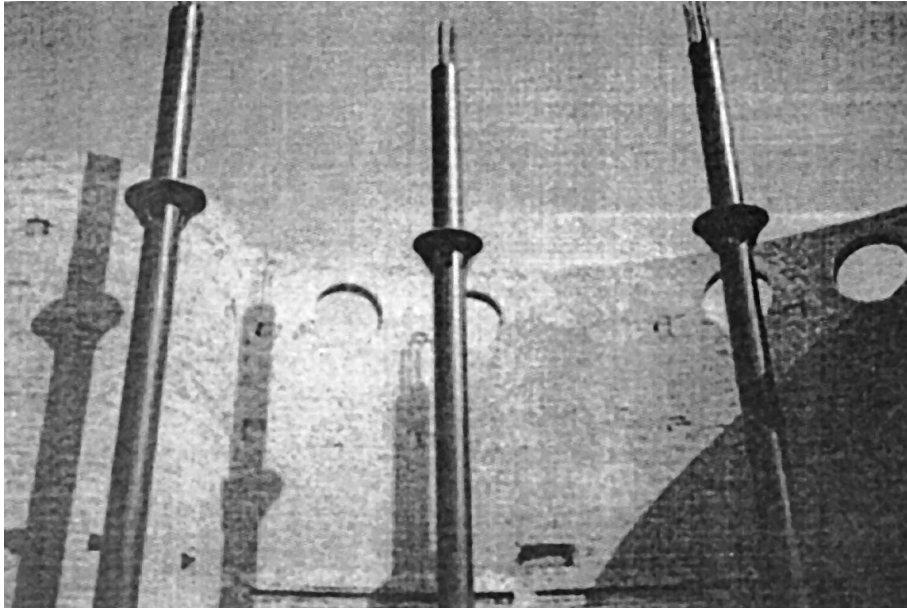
Трубобетонная колонна на строительстве храма Веры, Надежды, Любви в г. Полтаве
